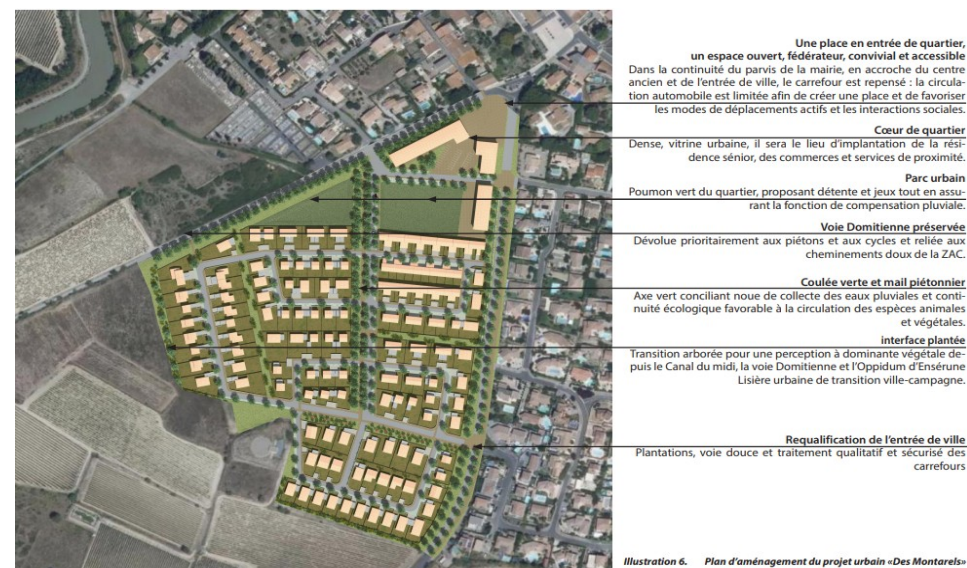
plan d'aménagement de la ZAC (source : étude d'impact)
